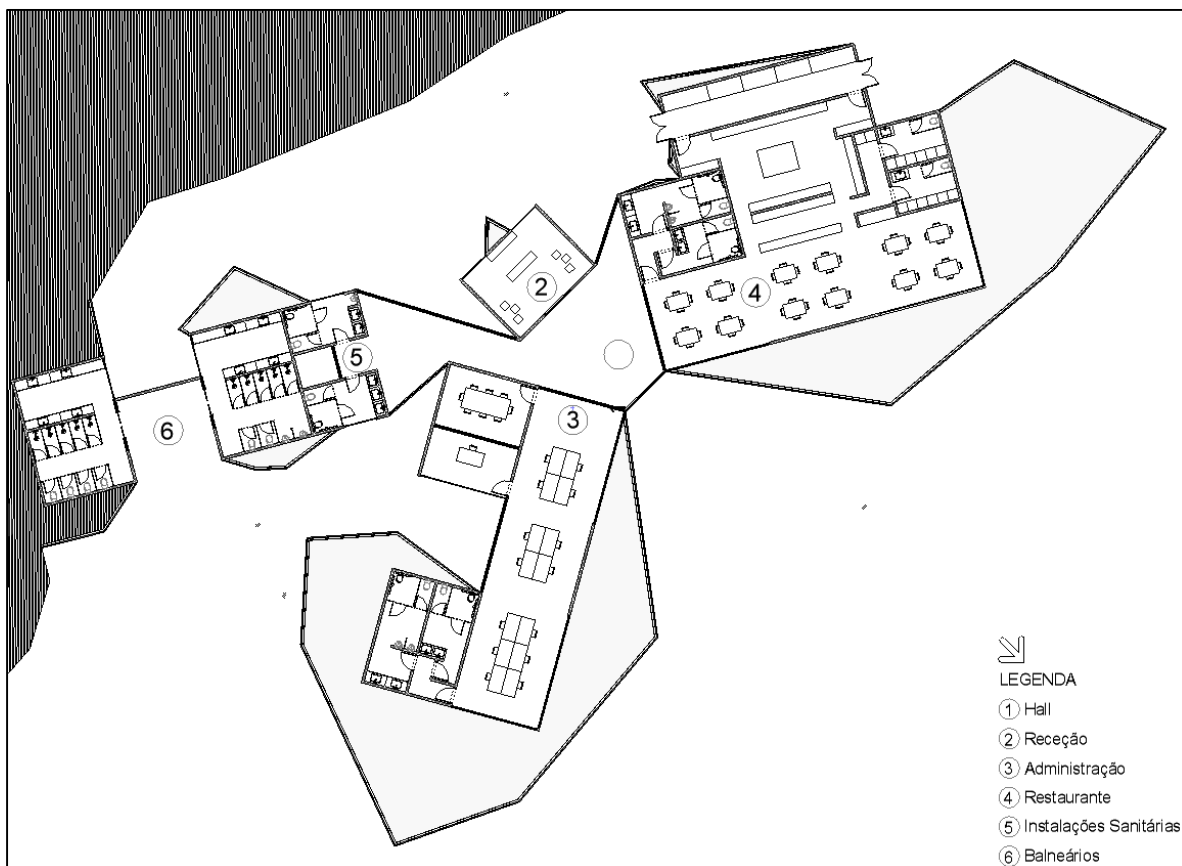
Planta piso 0 - Receção do Parque de EcoTurismo (sem escala).
